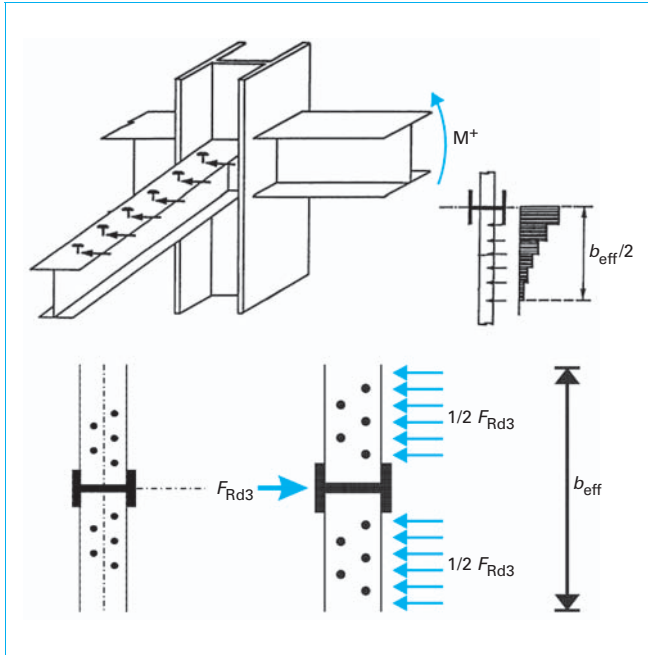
Mécanisme 3 : la compression en dehors du poteau reprise par les connecteurs d'une poutre de façade en acier
